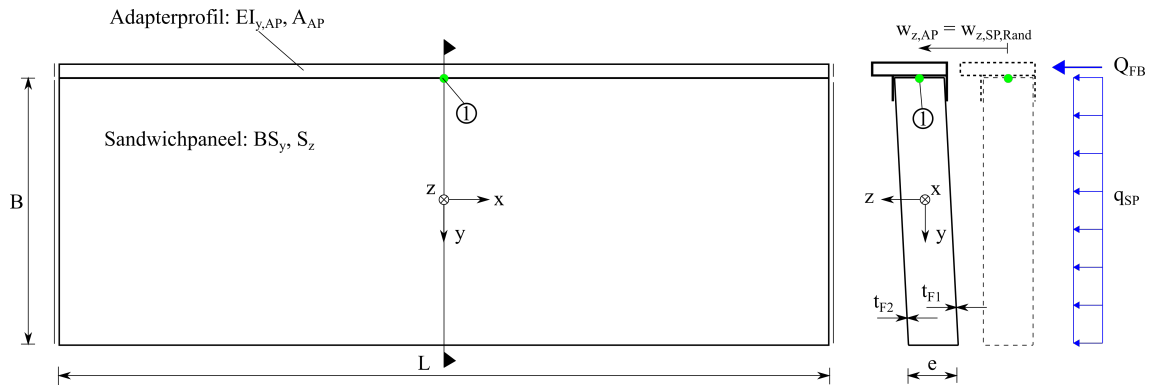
Statisches System Sandwichpaneel-Adapterprofil mit Belastung quer zur Fassadenebene
